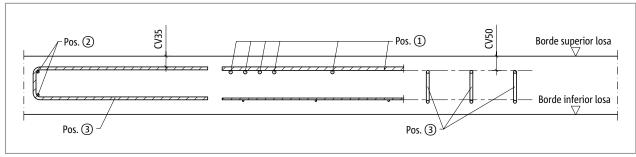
Schöck Isokorb® XT tipo C: Armadura in situ esquinero externo (sección XT tipo C-L-CV35, vista XT tipo C-R-CV50)
